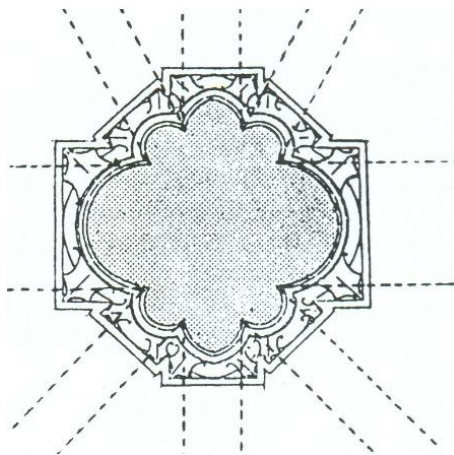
Pfeilergrundriss, Dommartin Abtei, 1153-1163.
